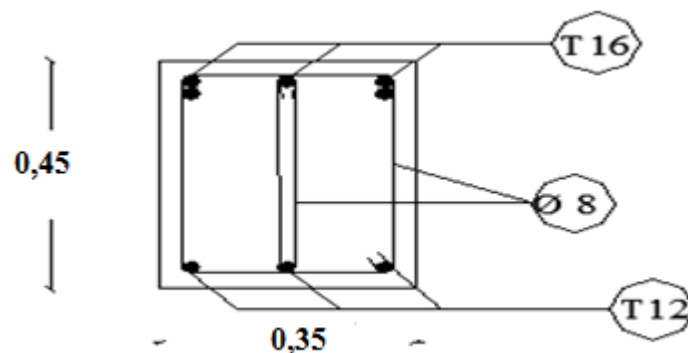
Ferrailage de la poutre principale en appui (sous sol).
